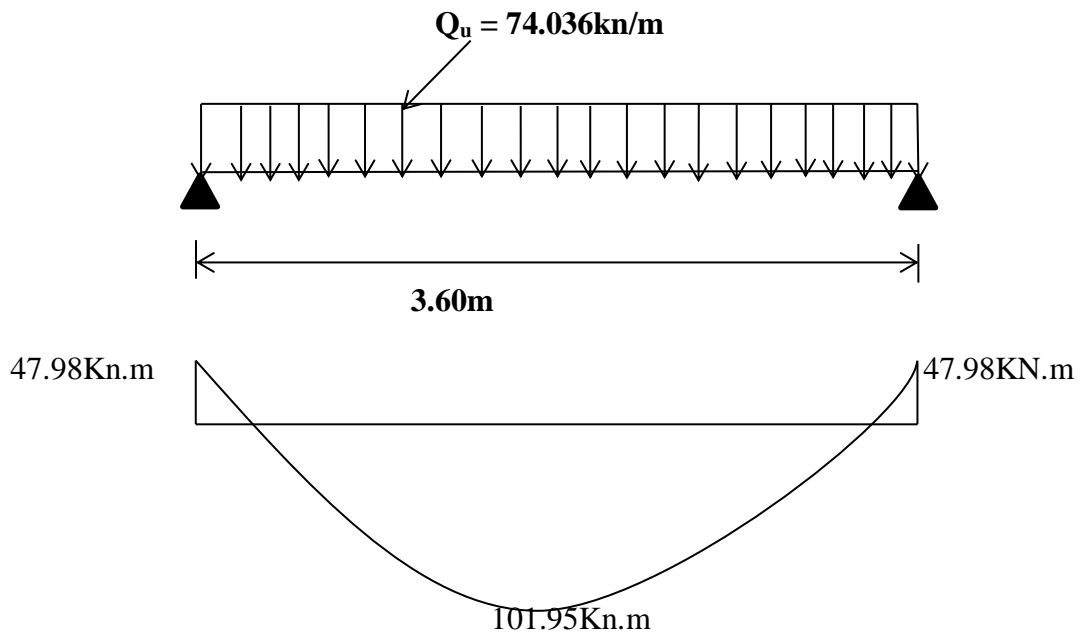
Schéma statique de la poutre palière de l'escalier.
